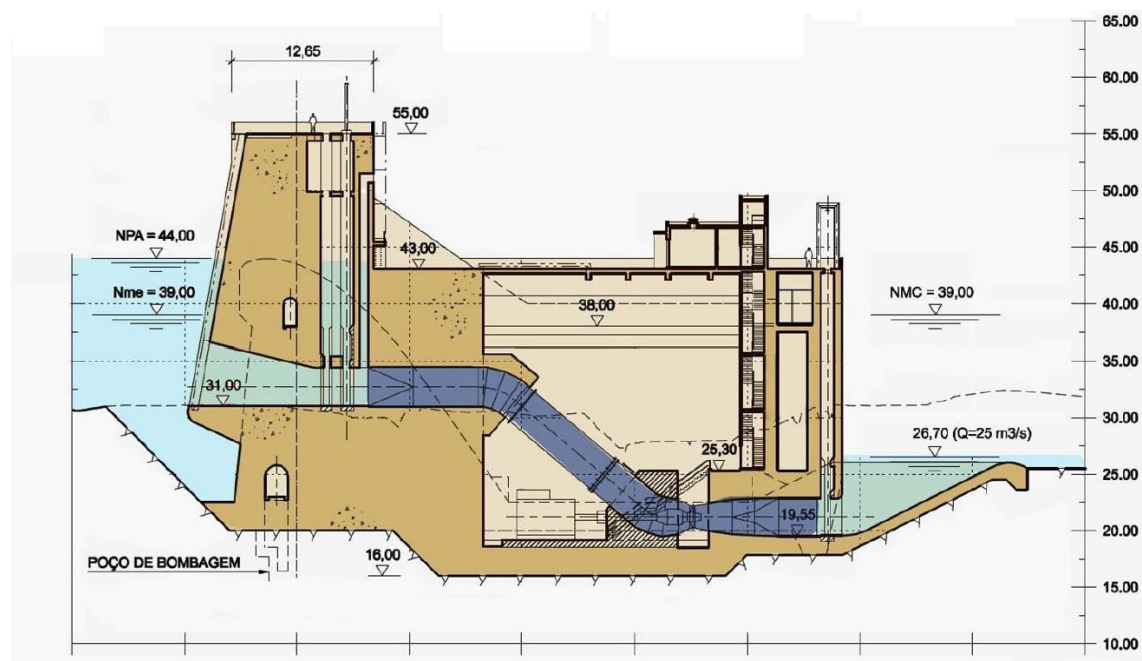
Corte de Perfil da central e barragem de Ermida [46]
